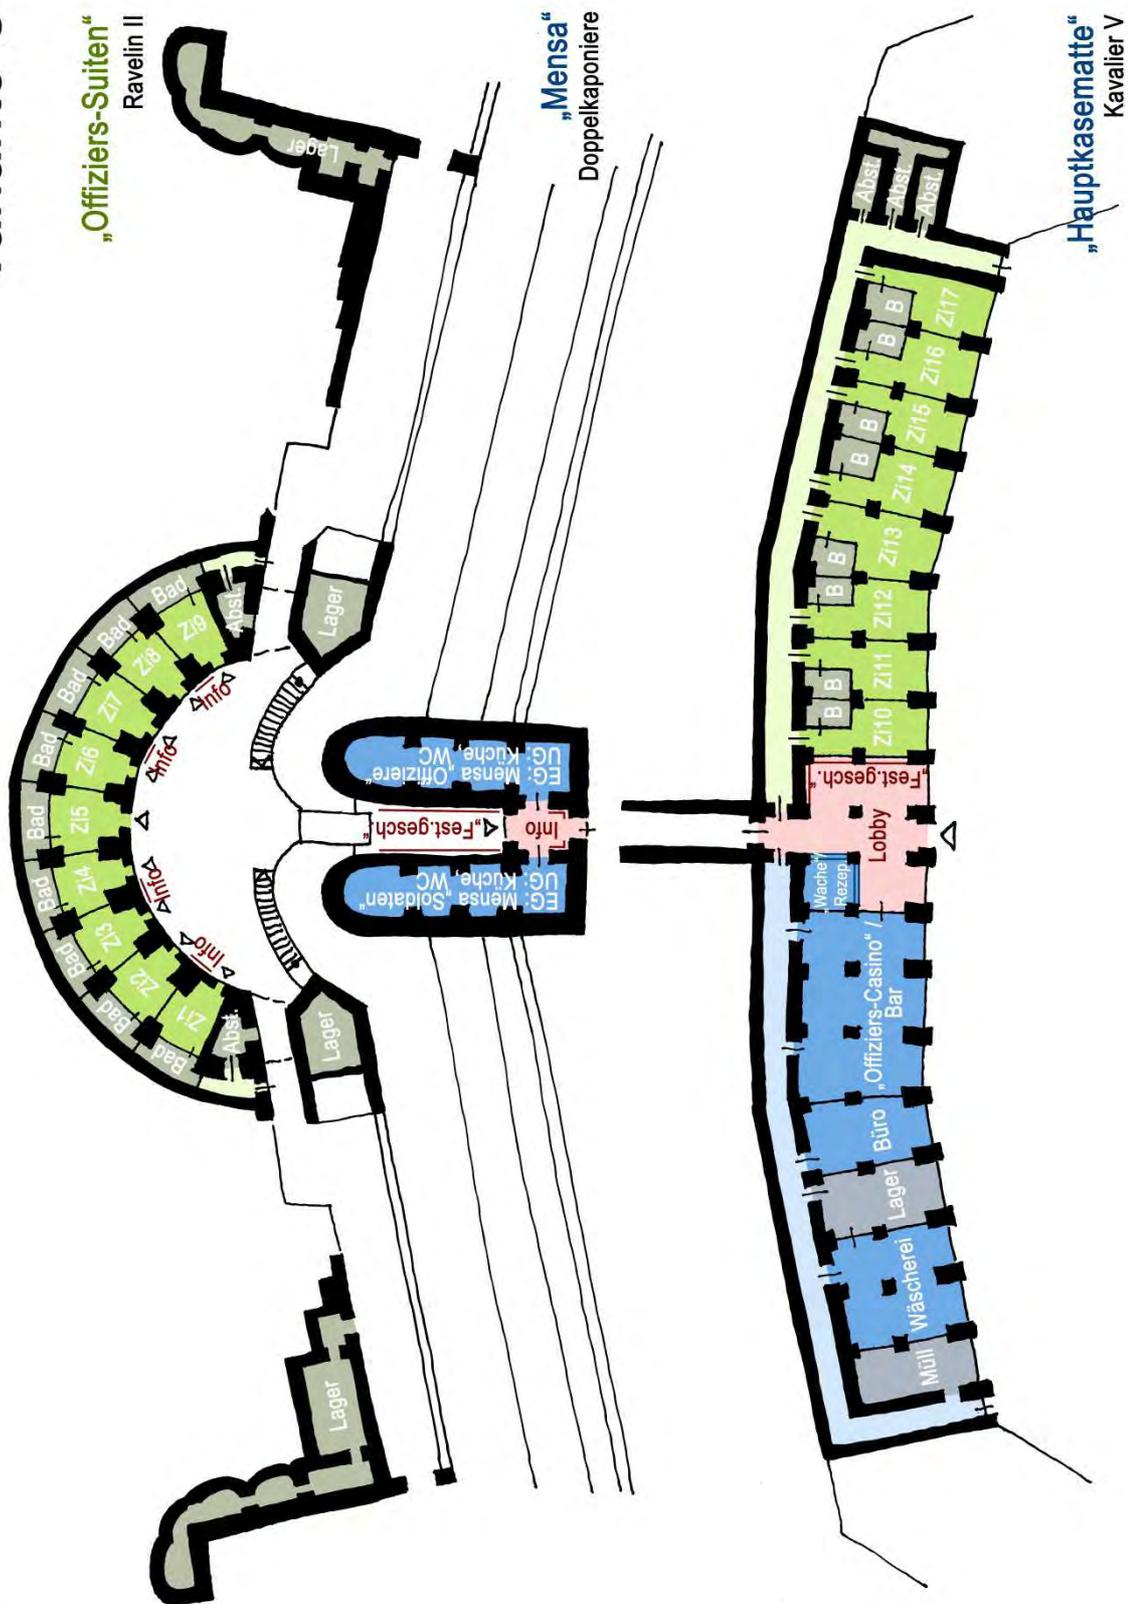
Grundrisskizze / Funktionsschema Variante C
